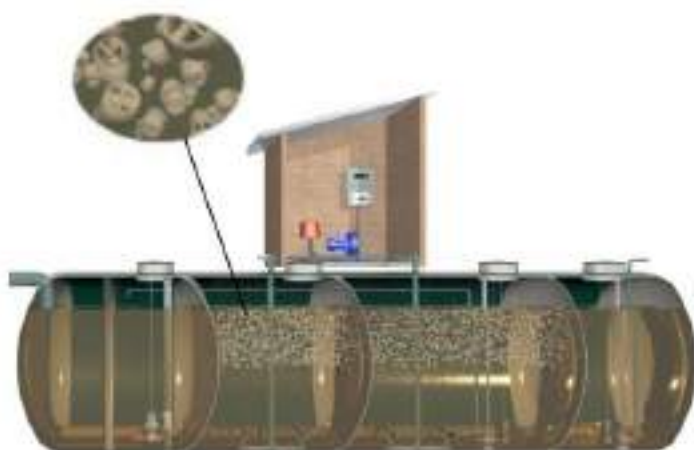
Plan du système de collecte des eaux usées (Source : ETG 2020)
